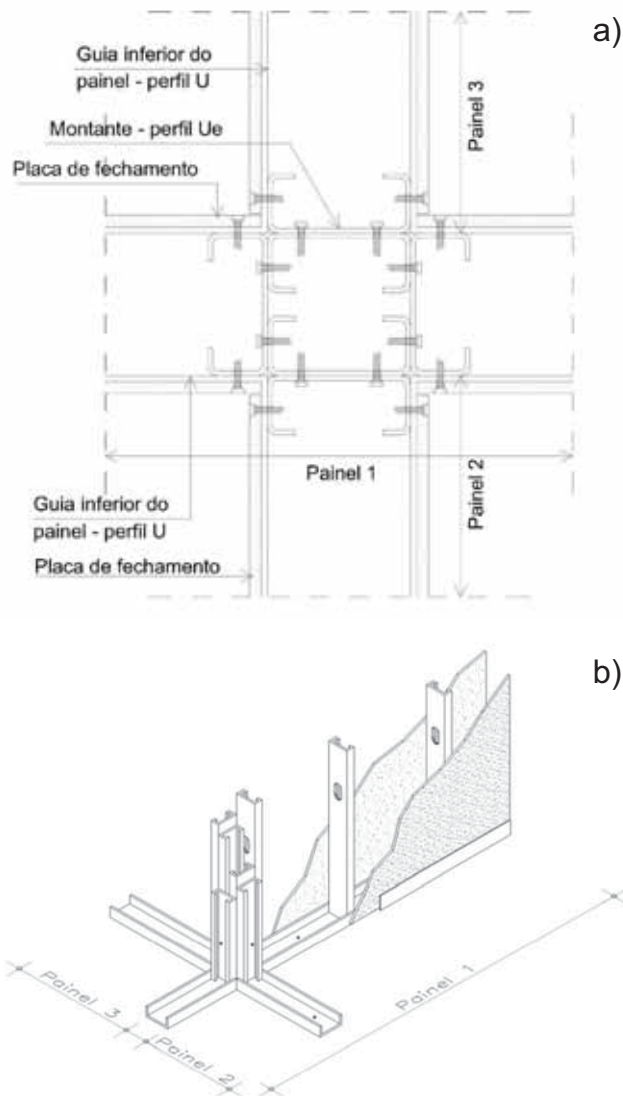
Encontro de três painéis: a) planta; b) perspectiva.
